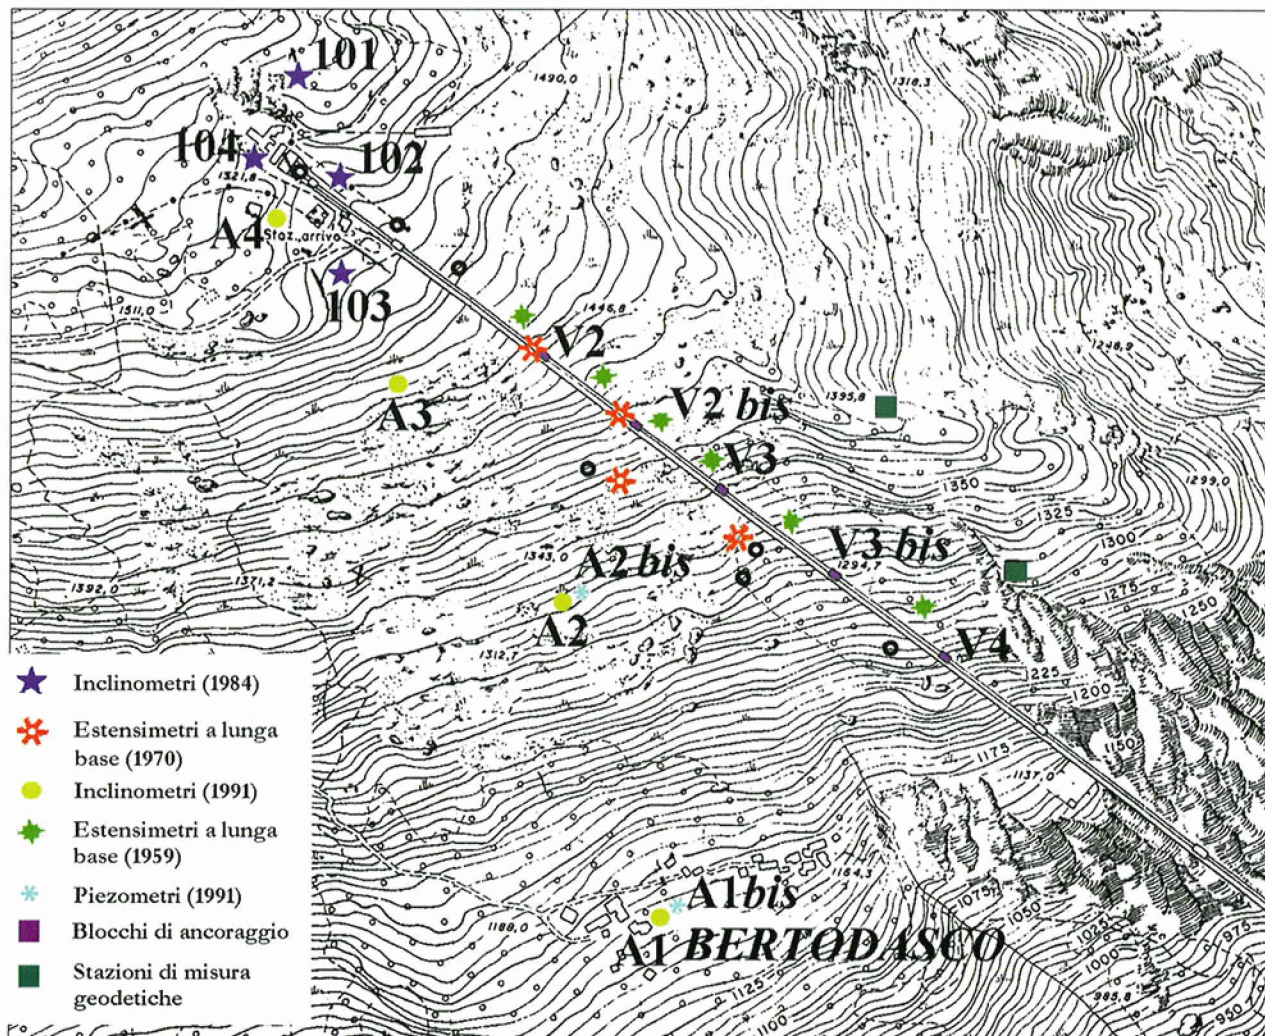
Ubicazione planimetrica dei sondaggi e dei blocchi di ancoraggio.
